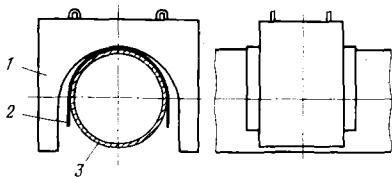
Схема установки железобетонного пригруза на трубопроводе диаметром 1420 мм:
